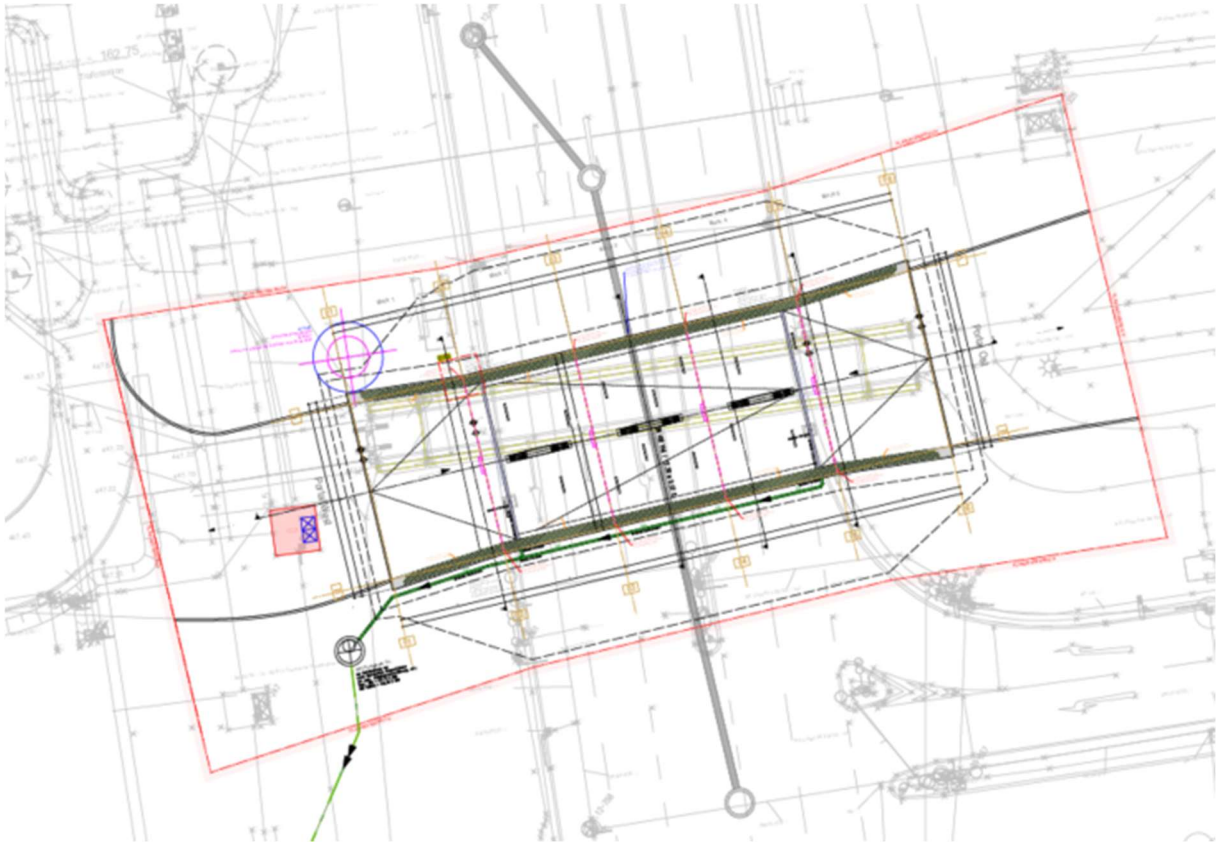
Grundriss Unterführung mit Aushub- und Baubereich
